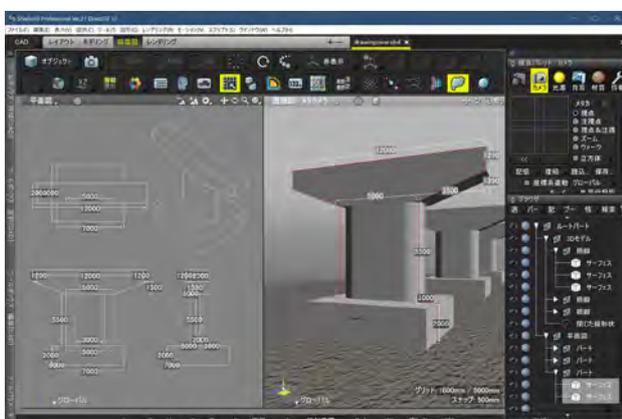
平面図表示(左)と平面図と3Dモデルの重ね合わせ(右)
